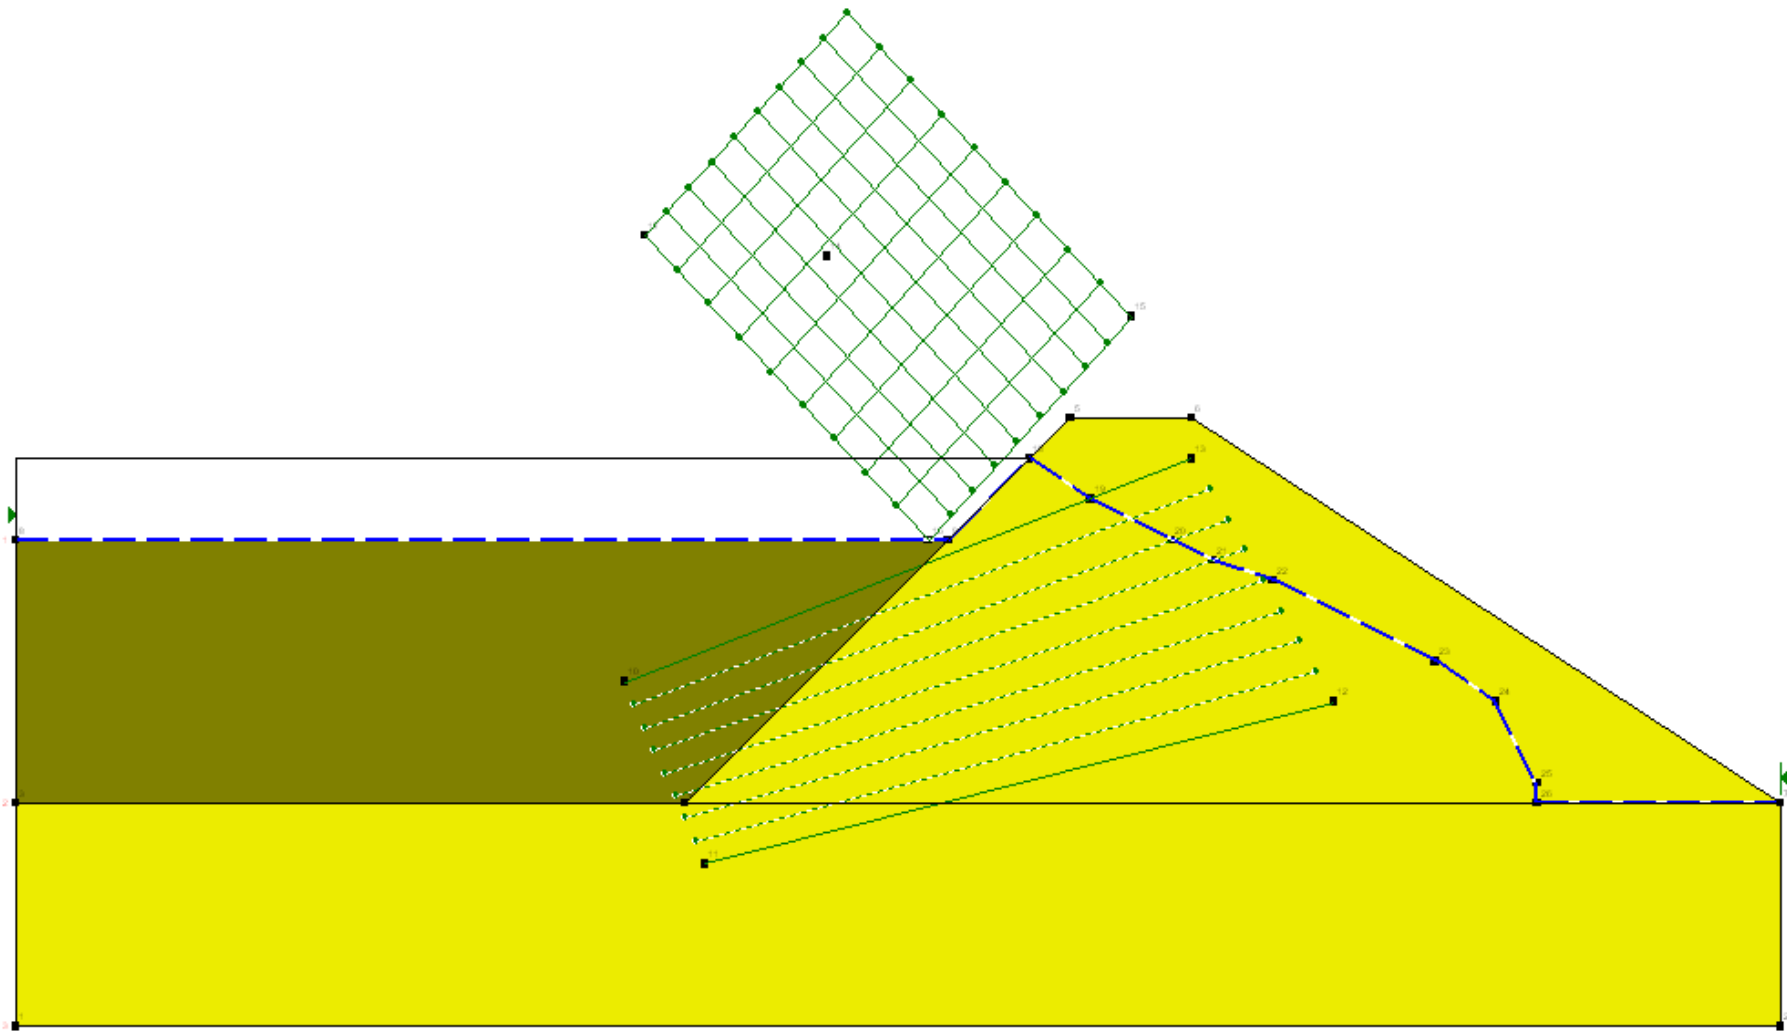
Modelo de cálculo con la presa en su estado inicial. 1ª tongada
